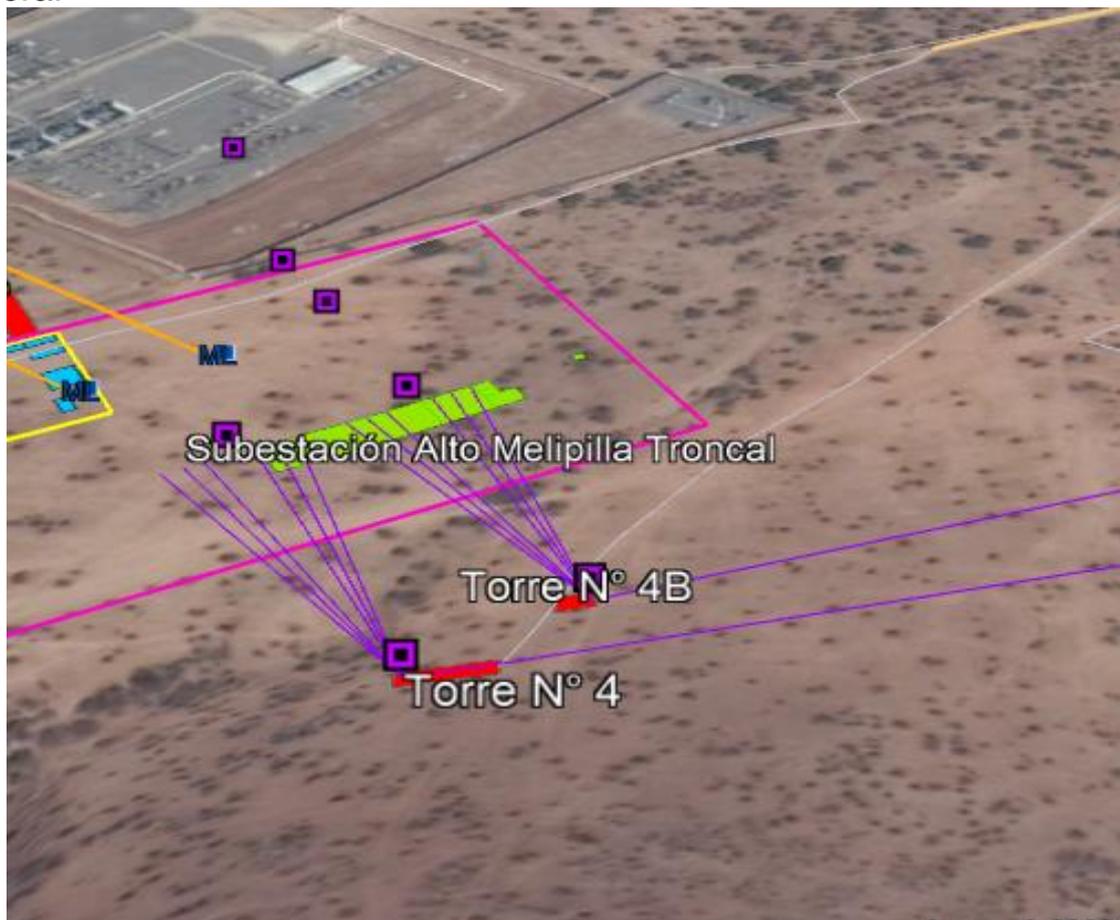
Emplazamiento de Estructura N° 4 y 4B Seccionamiento
